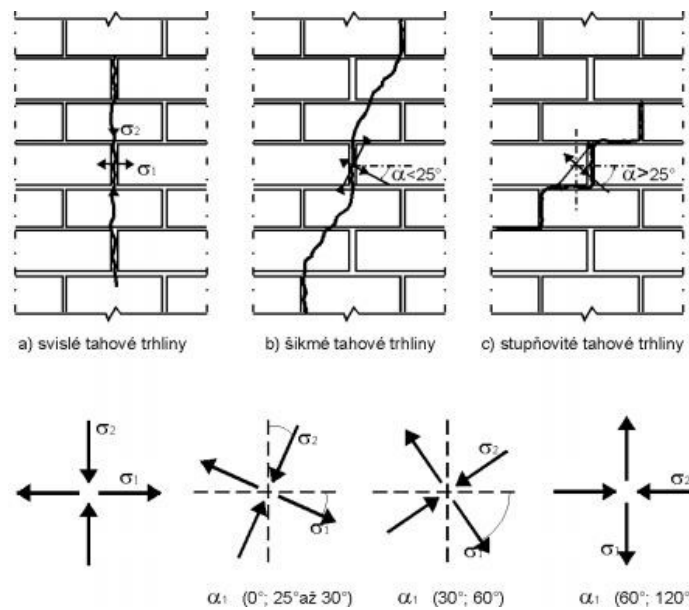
Postupný rozvoj tahových trhlin a porušování zděného pilíře [4]
